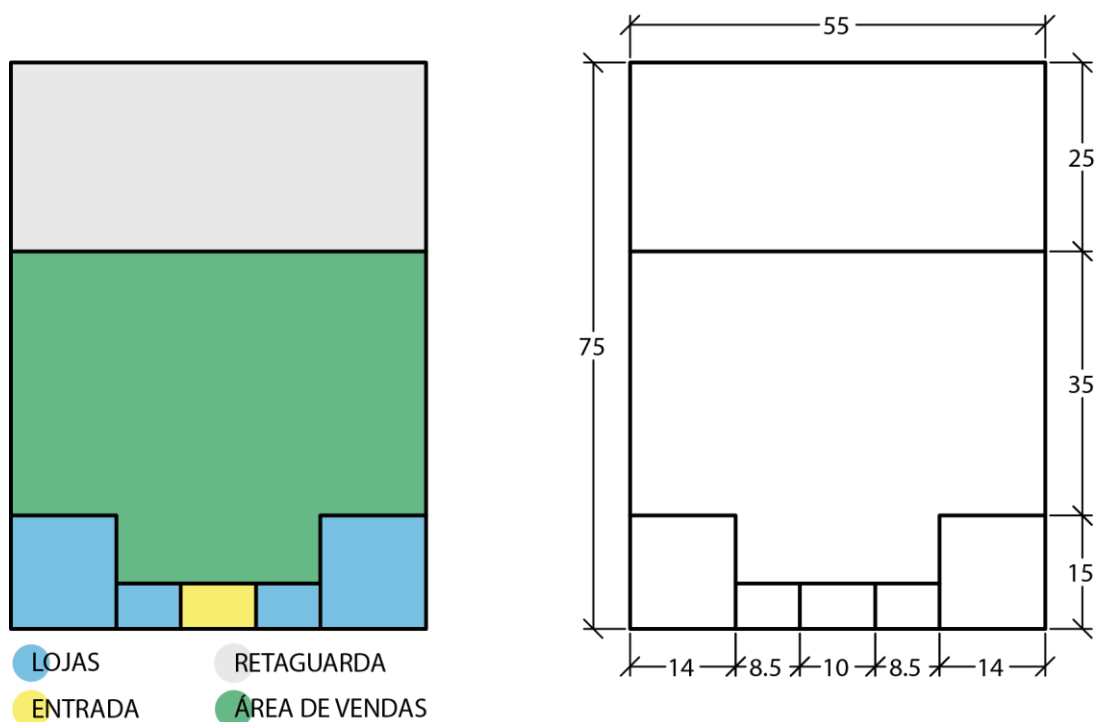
a. Organização *layout*-tipo; b. Dimensões em planta do *layout*-tipo
